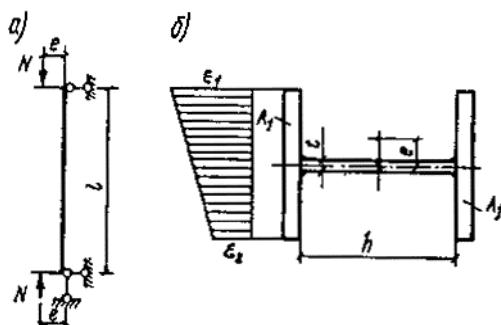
К расчету на устойчивость стенки сжатого стержня
